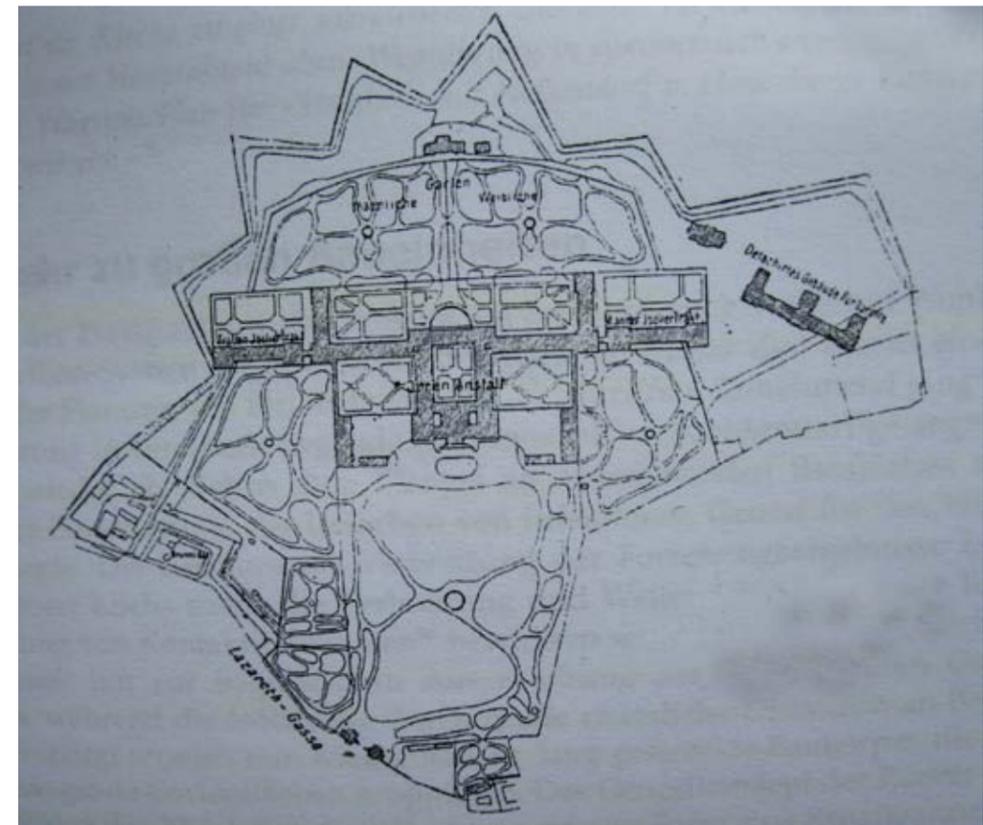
Lageplan „Irrenanstalt Brünfeld“, im 9 Wiener Gemeindebezirk
